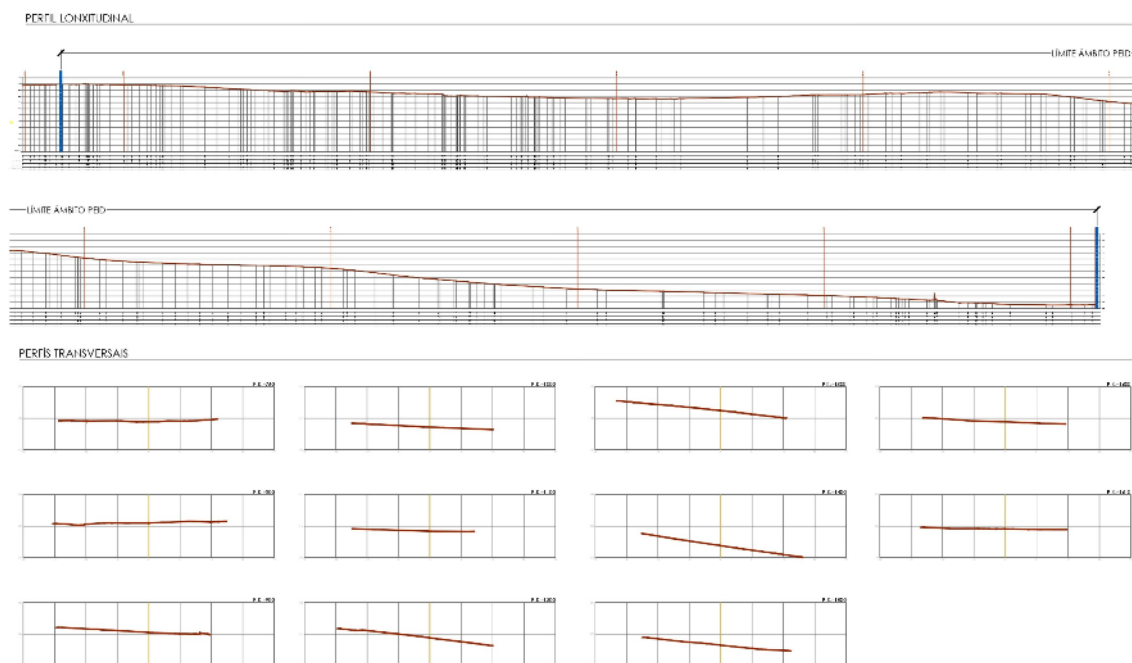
Perfil topográfico lonxitudinal con diversas seccións transversais.
